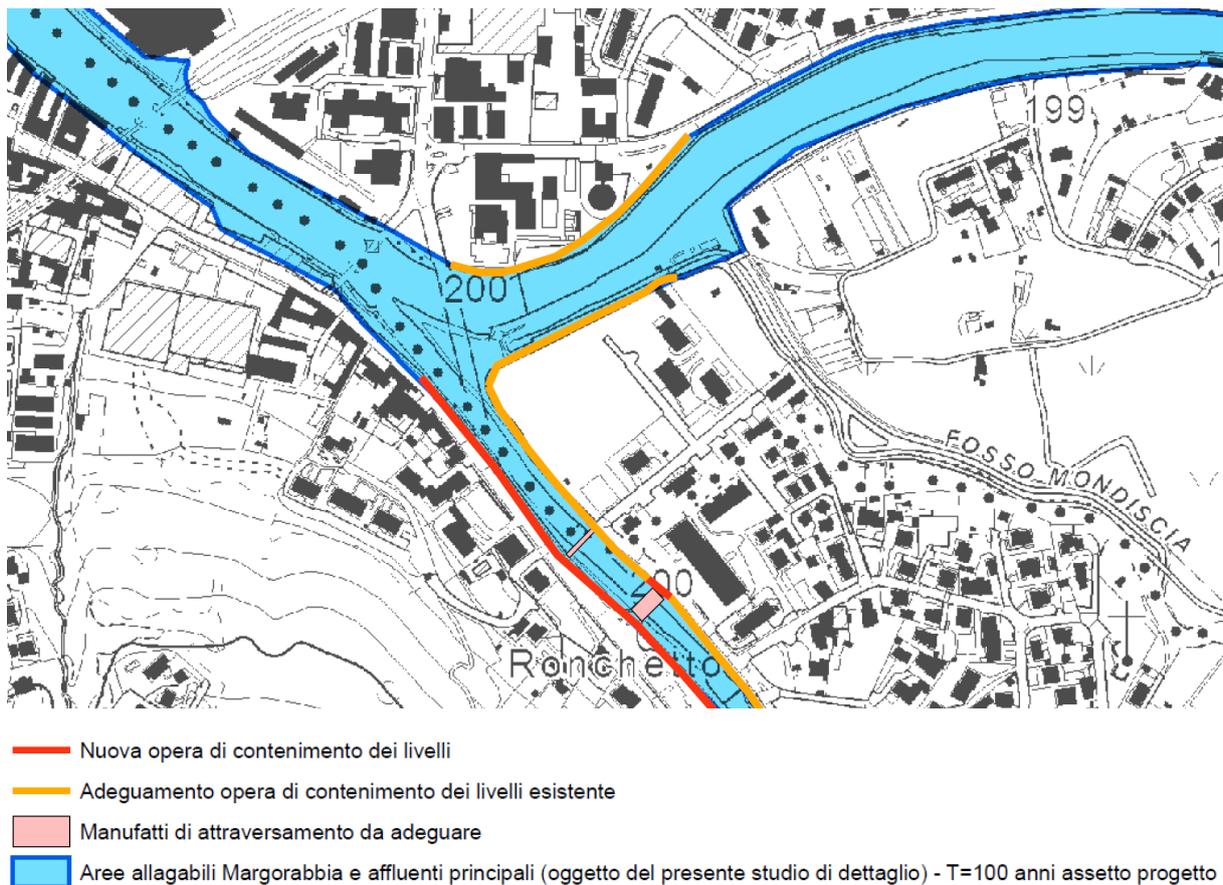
Planimetria assetto di progetto - opere e aree allagabili T=100 anni.
